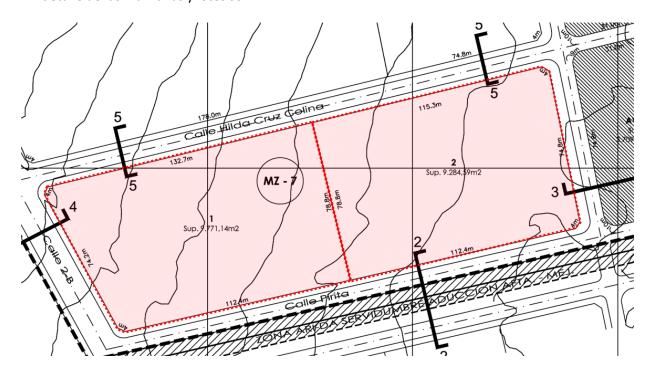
Ubicación Lotes 1 y 2 de la MZ-7. Fuente: Extracto Plano Anteproyecto de Loteo Etapa II, Seremi MINVU.
